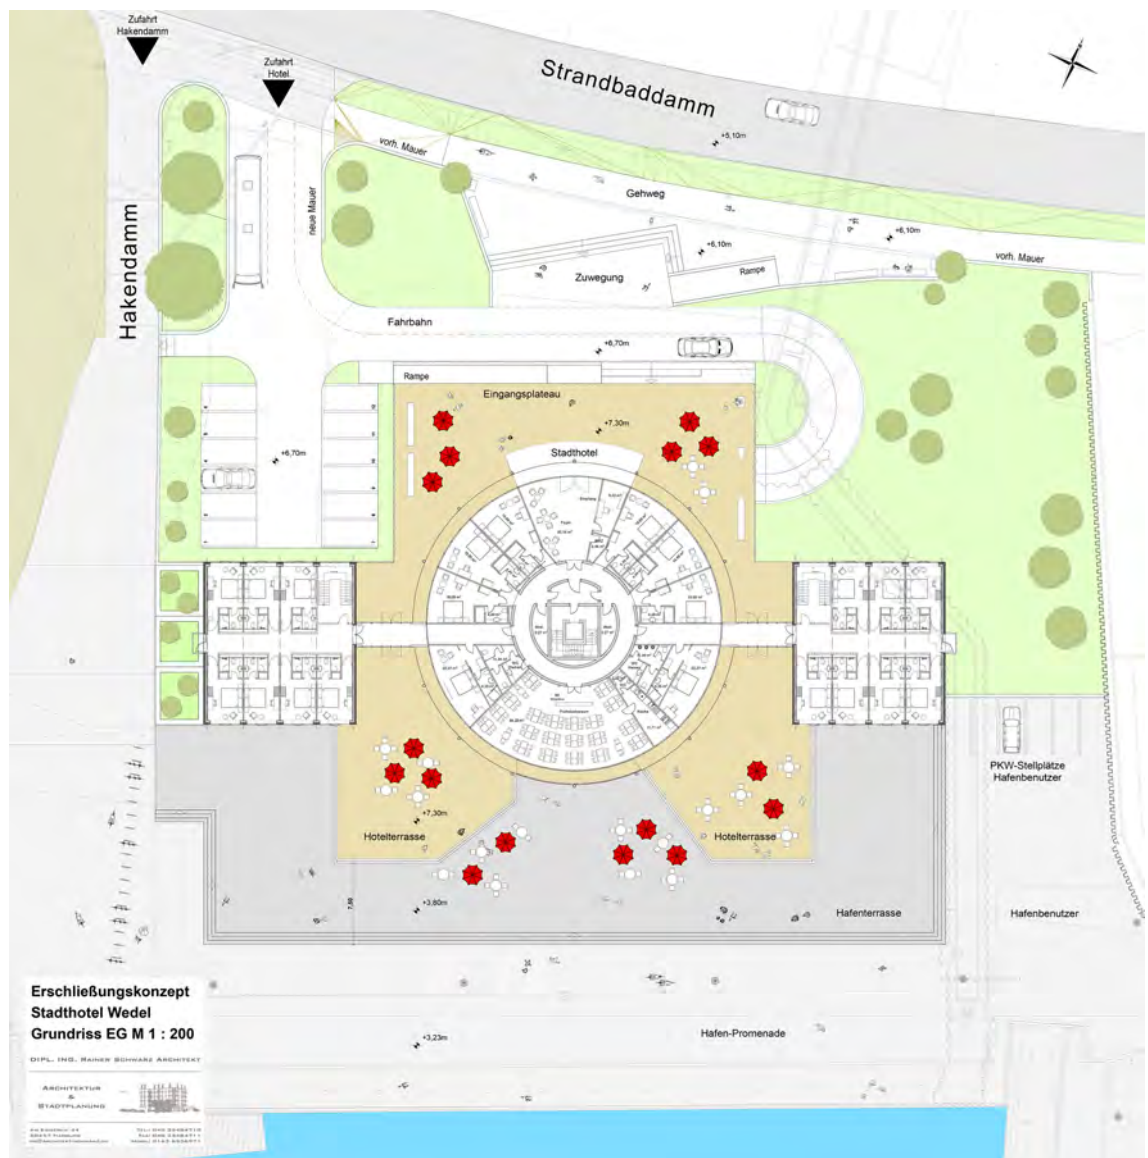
Grundriss Hotel Stadthafen Wedel, Stand 23.11.2016
